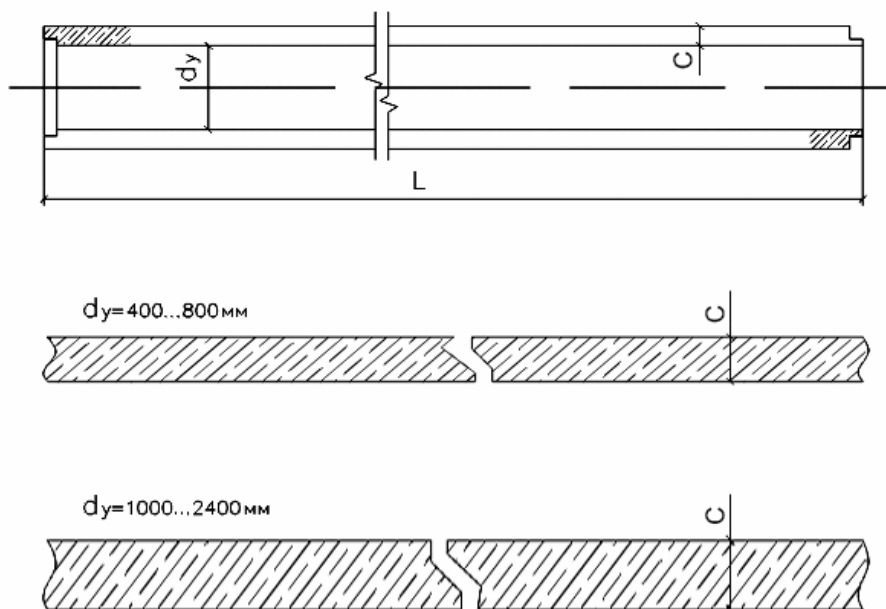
Трубы железобетонные безнапорные типа ФТ
